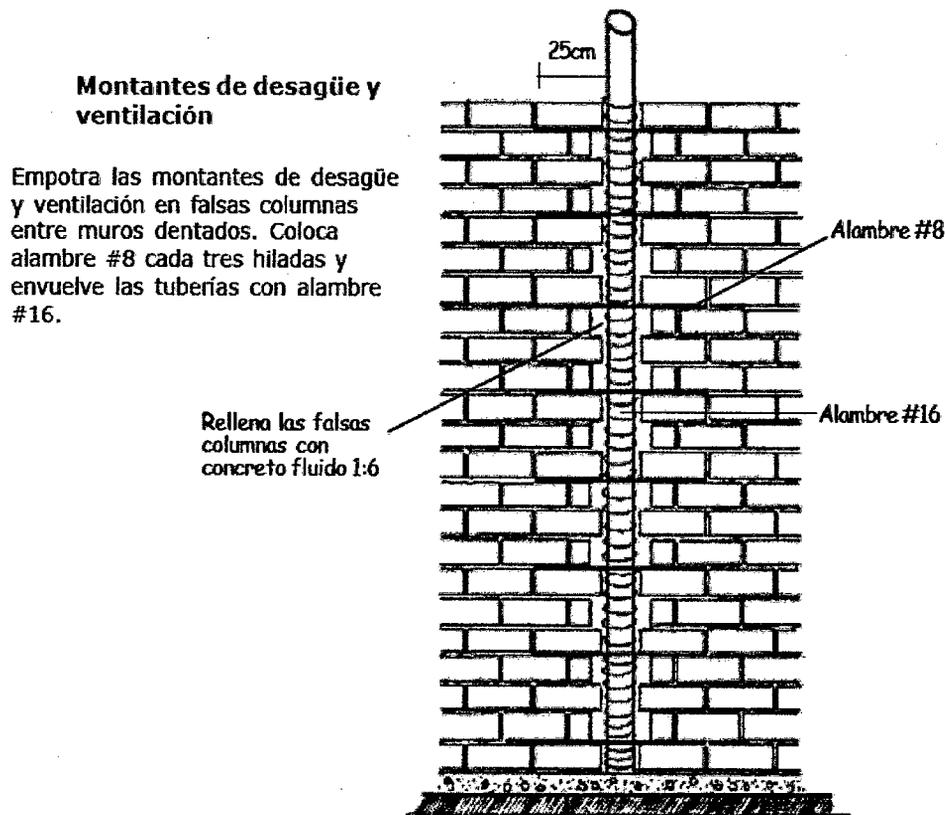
Colocación de tuberías en muros (Construcción y Mantenimiento de viviendas de albañilería 2005).
